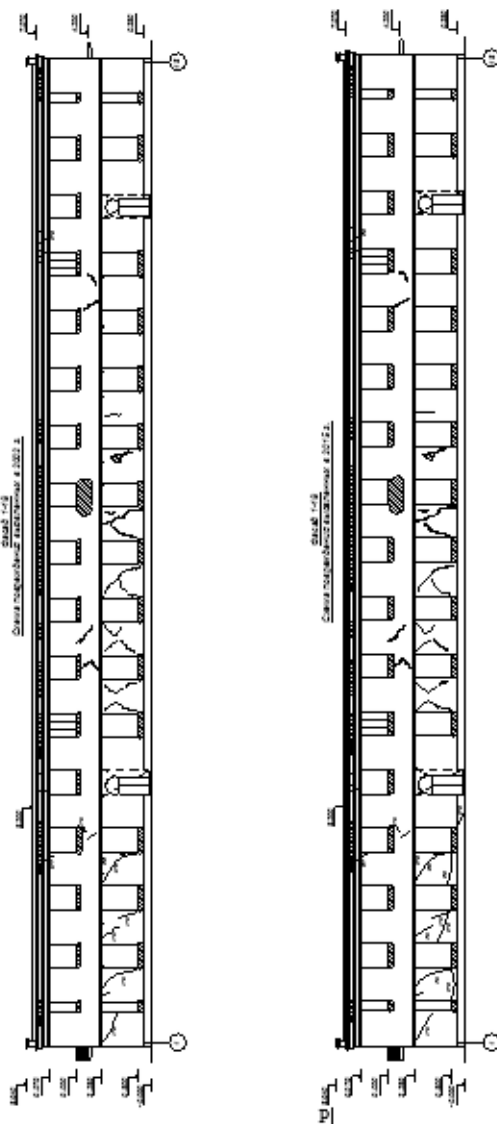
Схемы повреждений по фасаду в осях «1-18»
